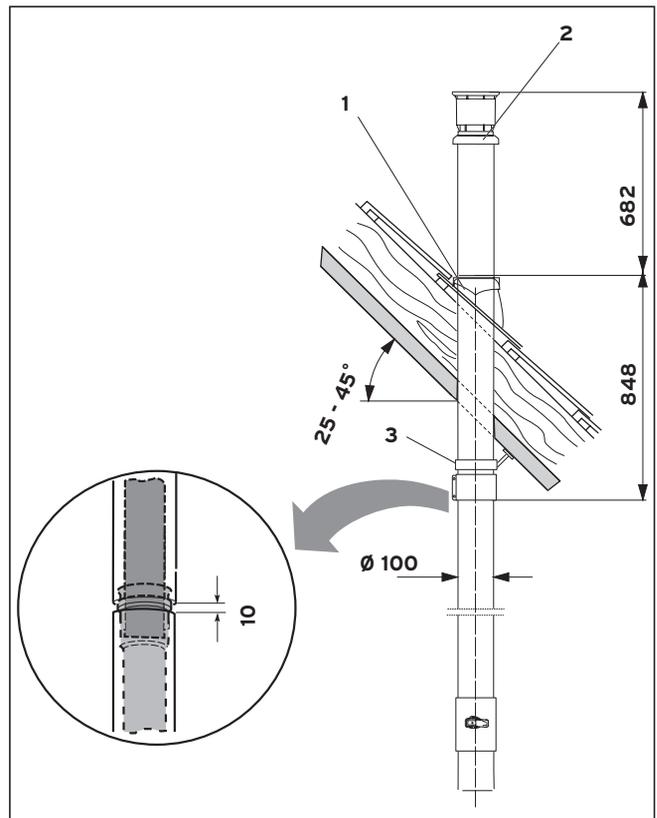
Montagebeispiel: Senkrechte Dachdurchführung
